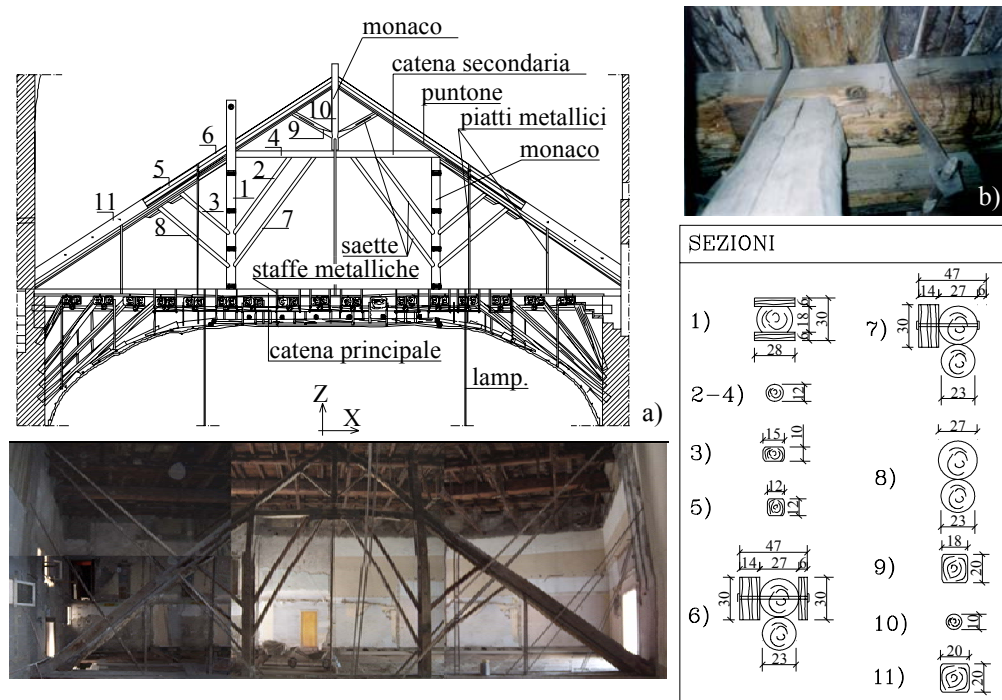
Capriata: a) Prospetto; b) Particolare collegamento travi-catena; c) Sezione trasversale degli elementi.
